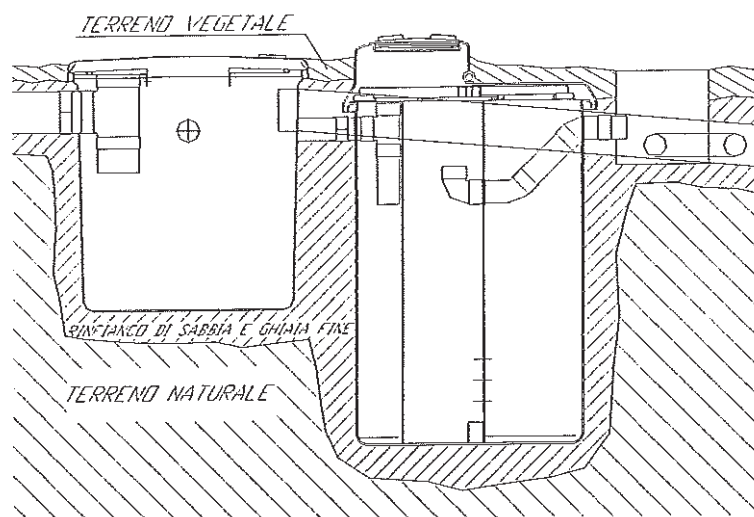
Sezione tipo dell'impianto di trattamento acque meteoriche.
